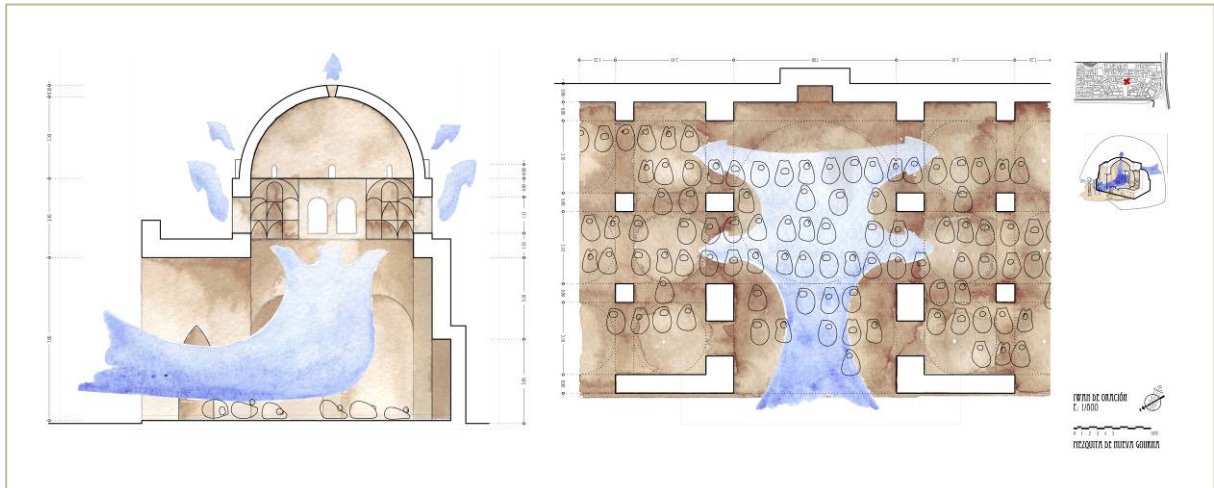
Secciones y planta del espacio principal de oración de la mezquita en Nueva Gurna. Redibujado por Javier Parra
